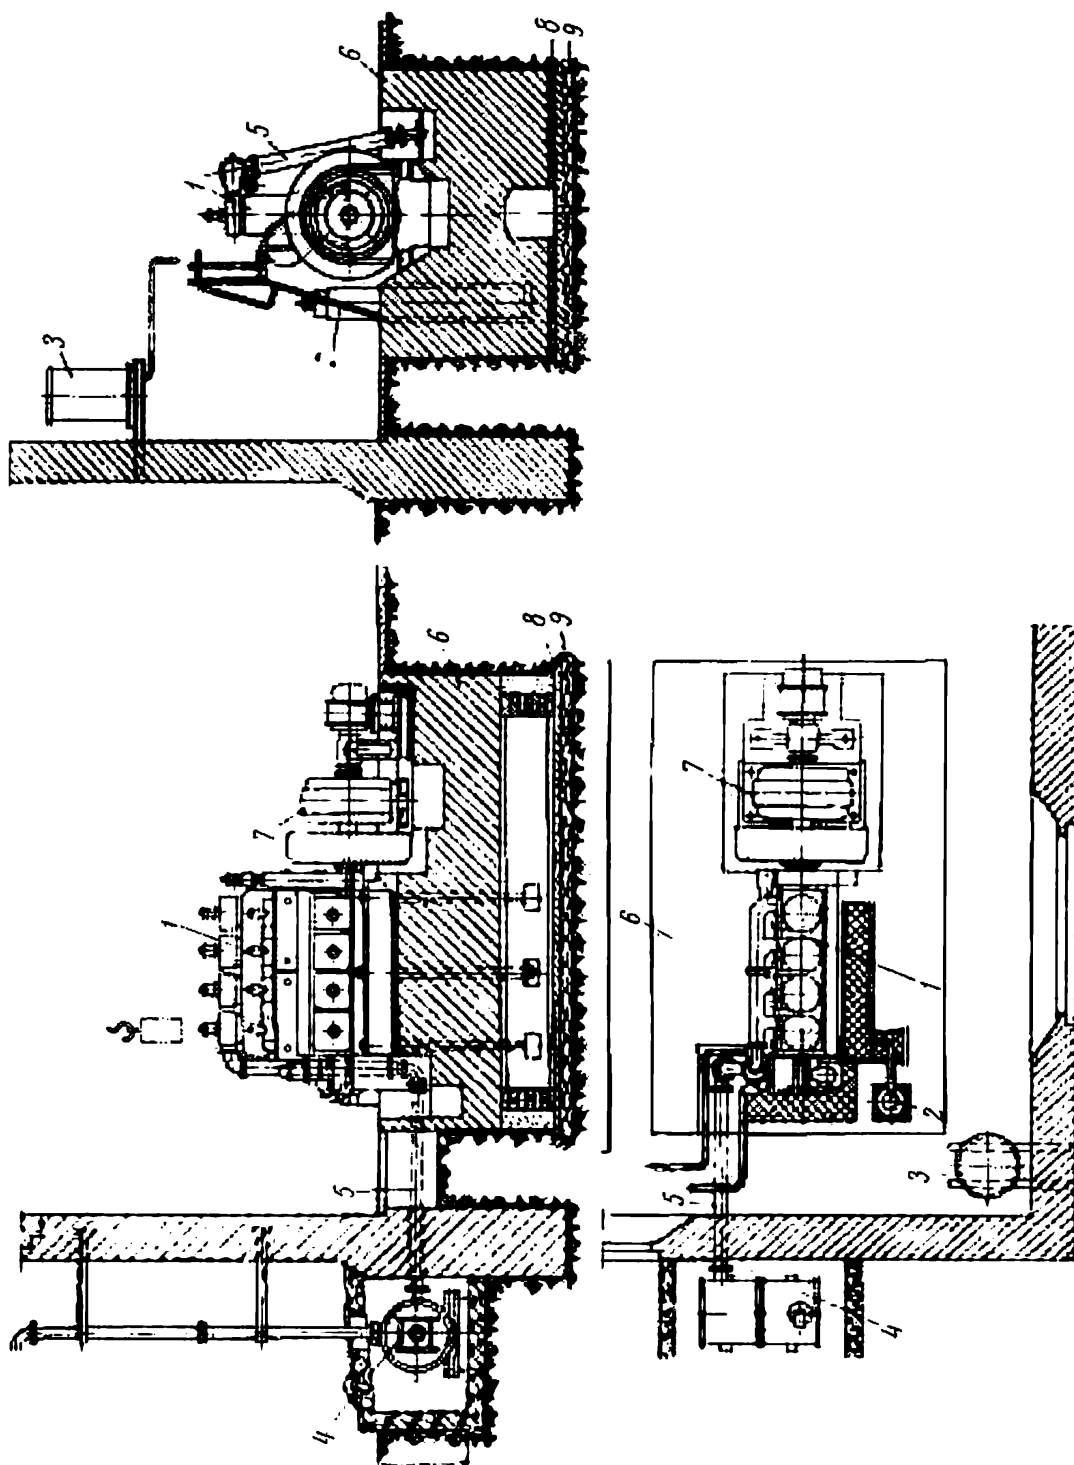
Exemple d'installation d'un moteur fixe 4Q-29/41,5 sur sa fondation
